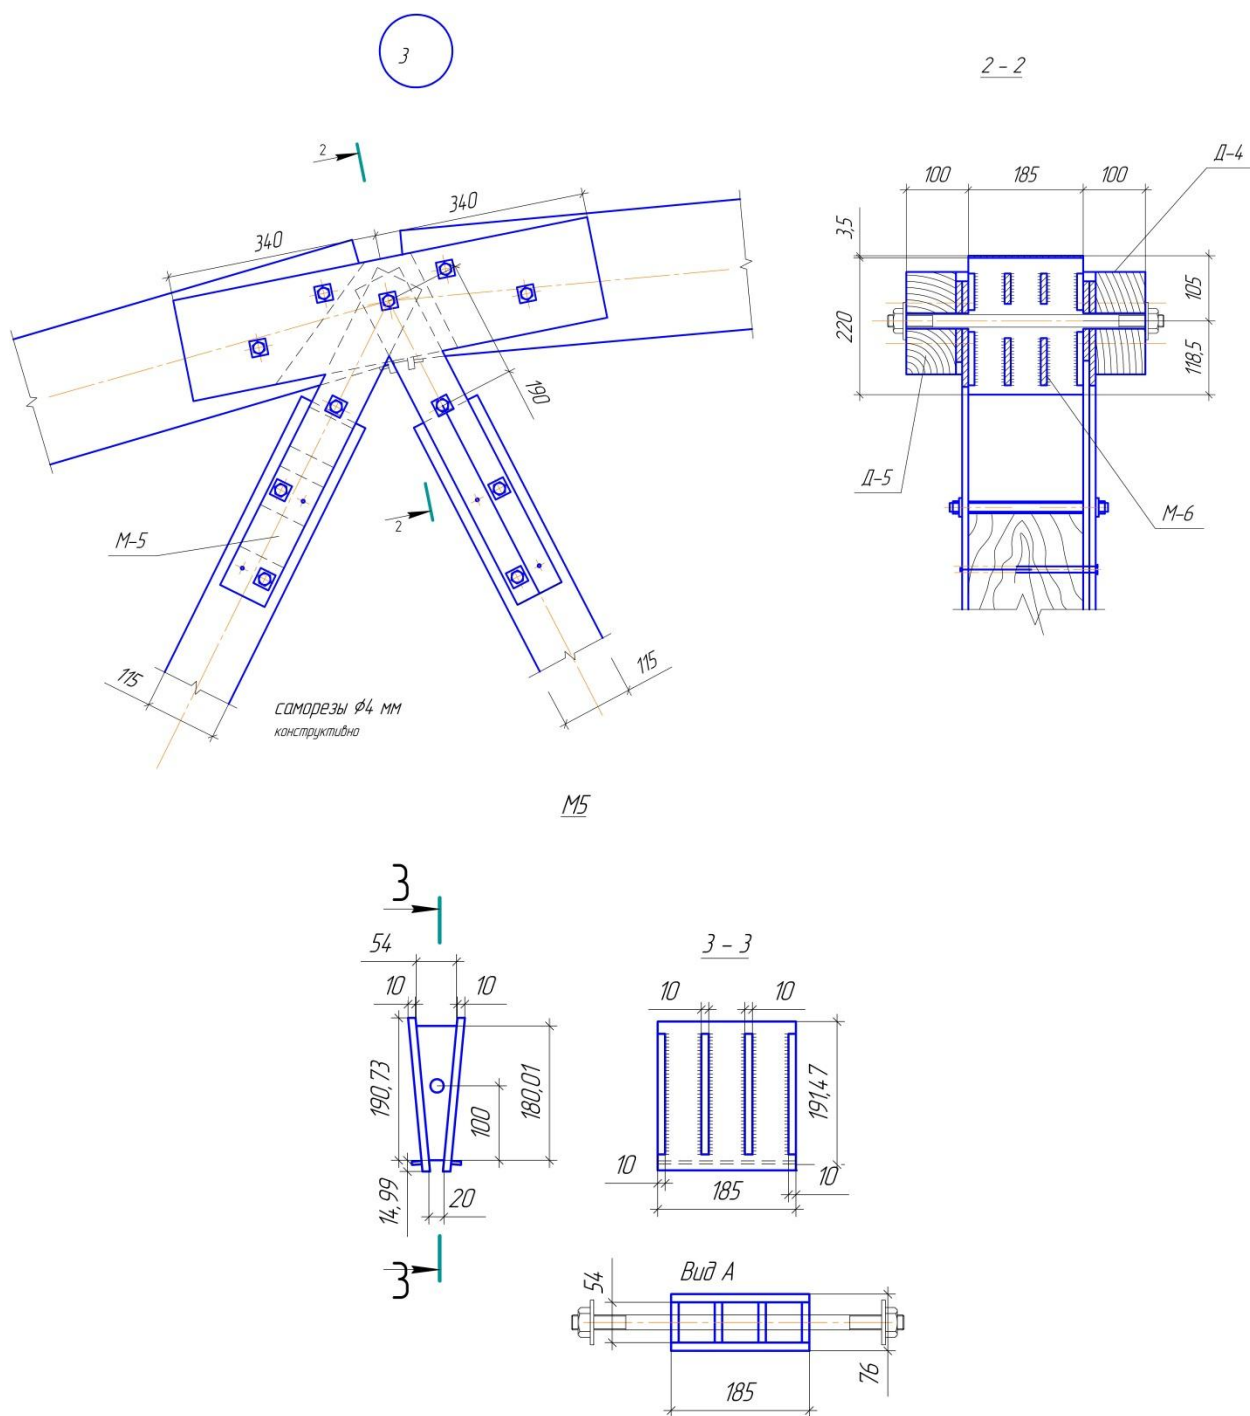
Конструкция узла В верхнего пояса фермы
